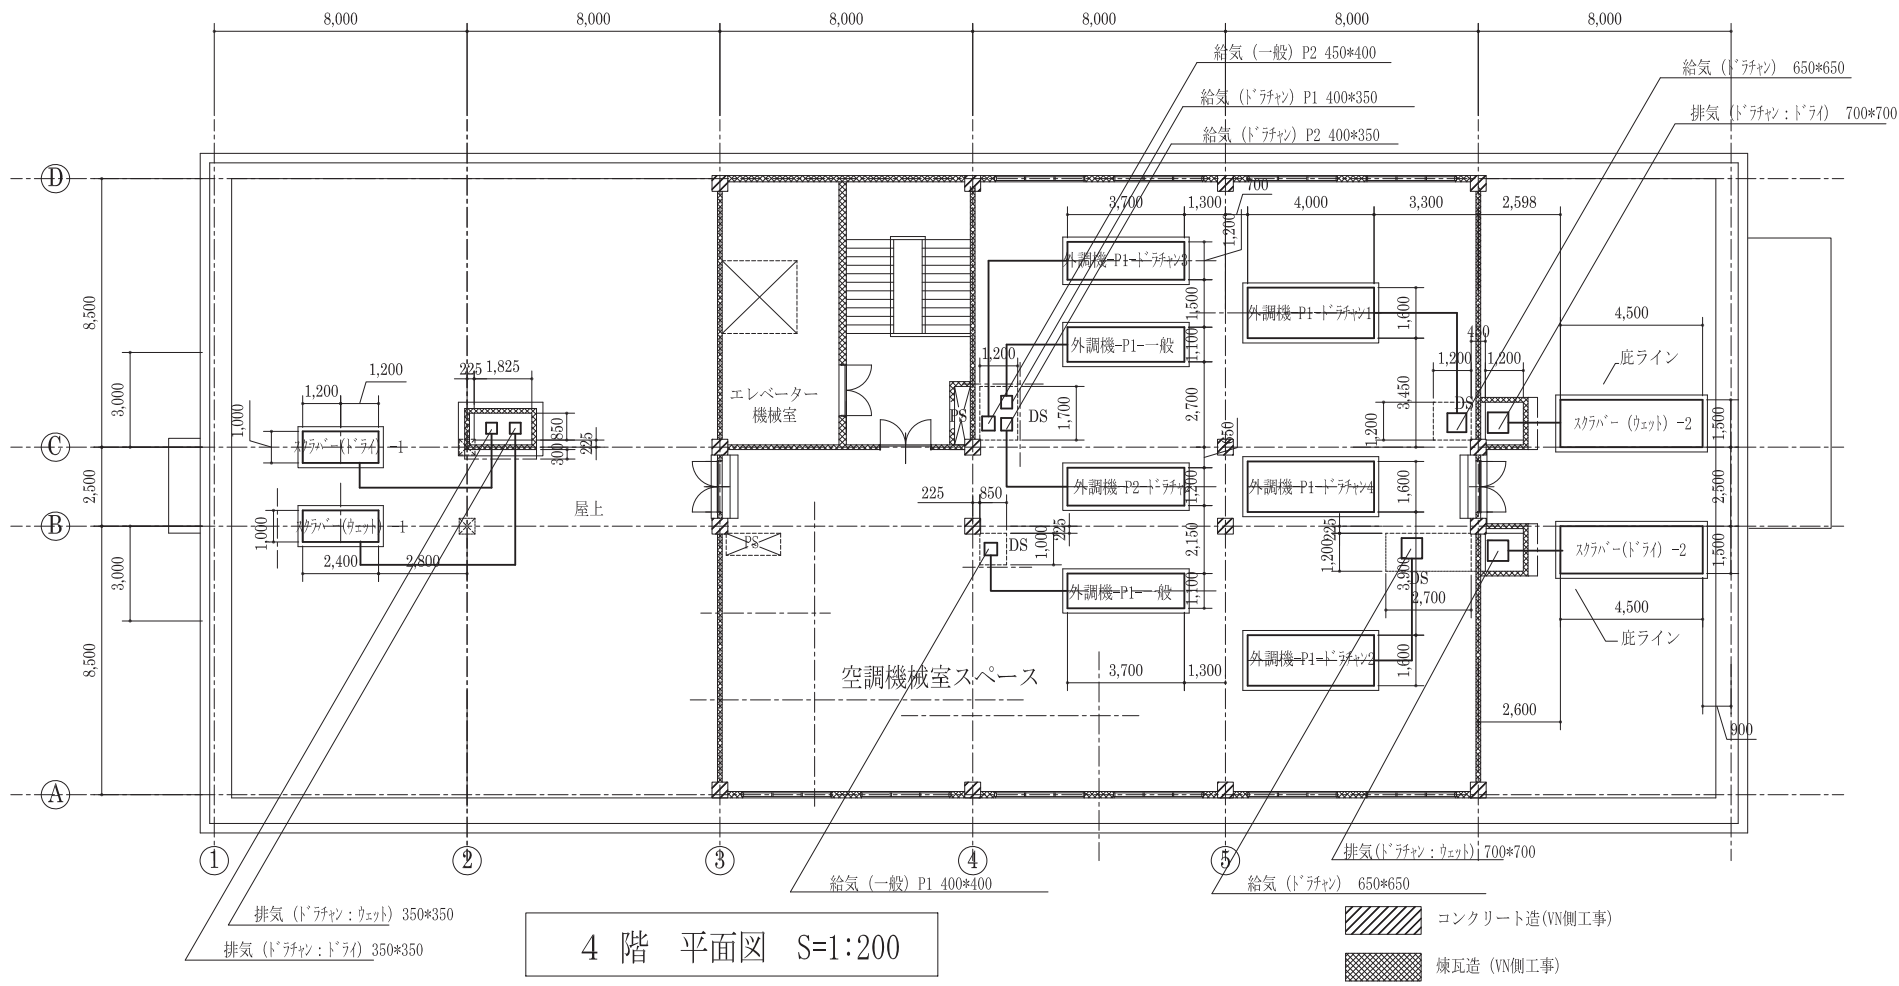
2 RETAQ センター検査棟 : 4階平面図
